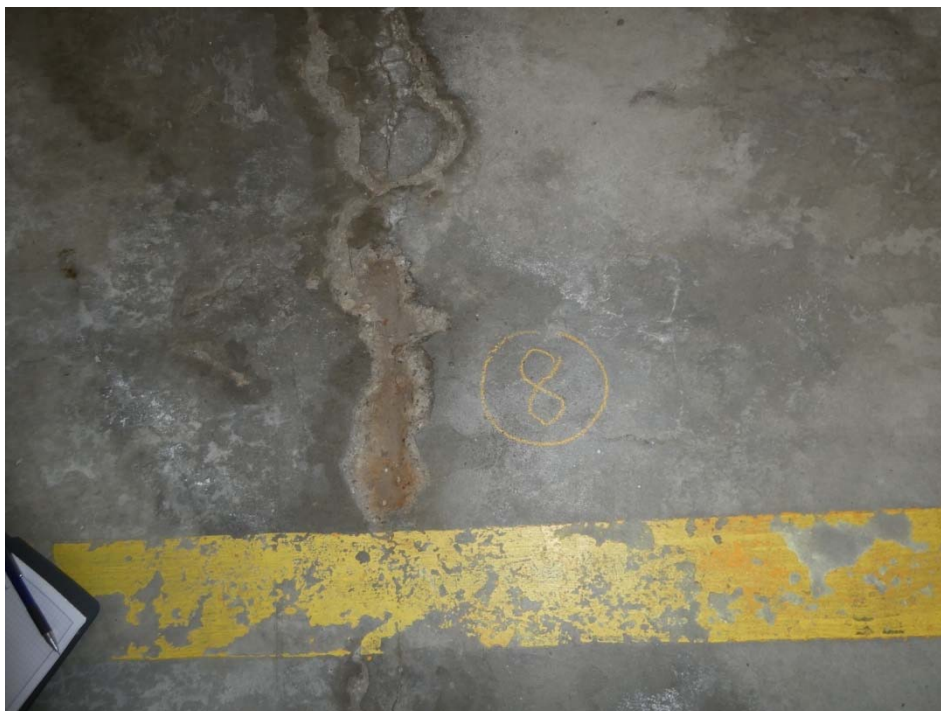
Untersuchungsstelle 8 – Bodenfläche Pfützenbereich mit korrodierter Bewehrung
